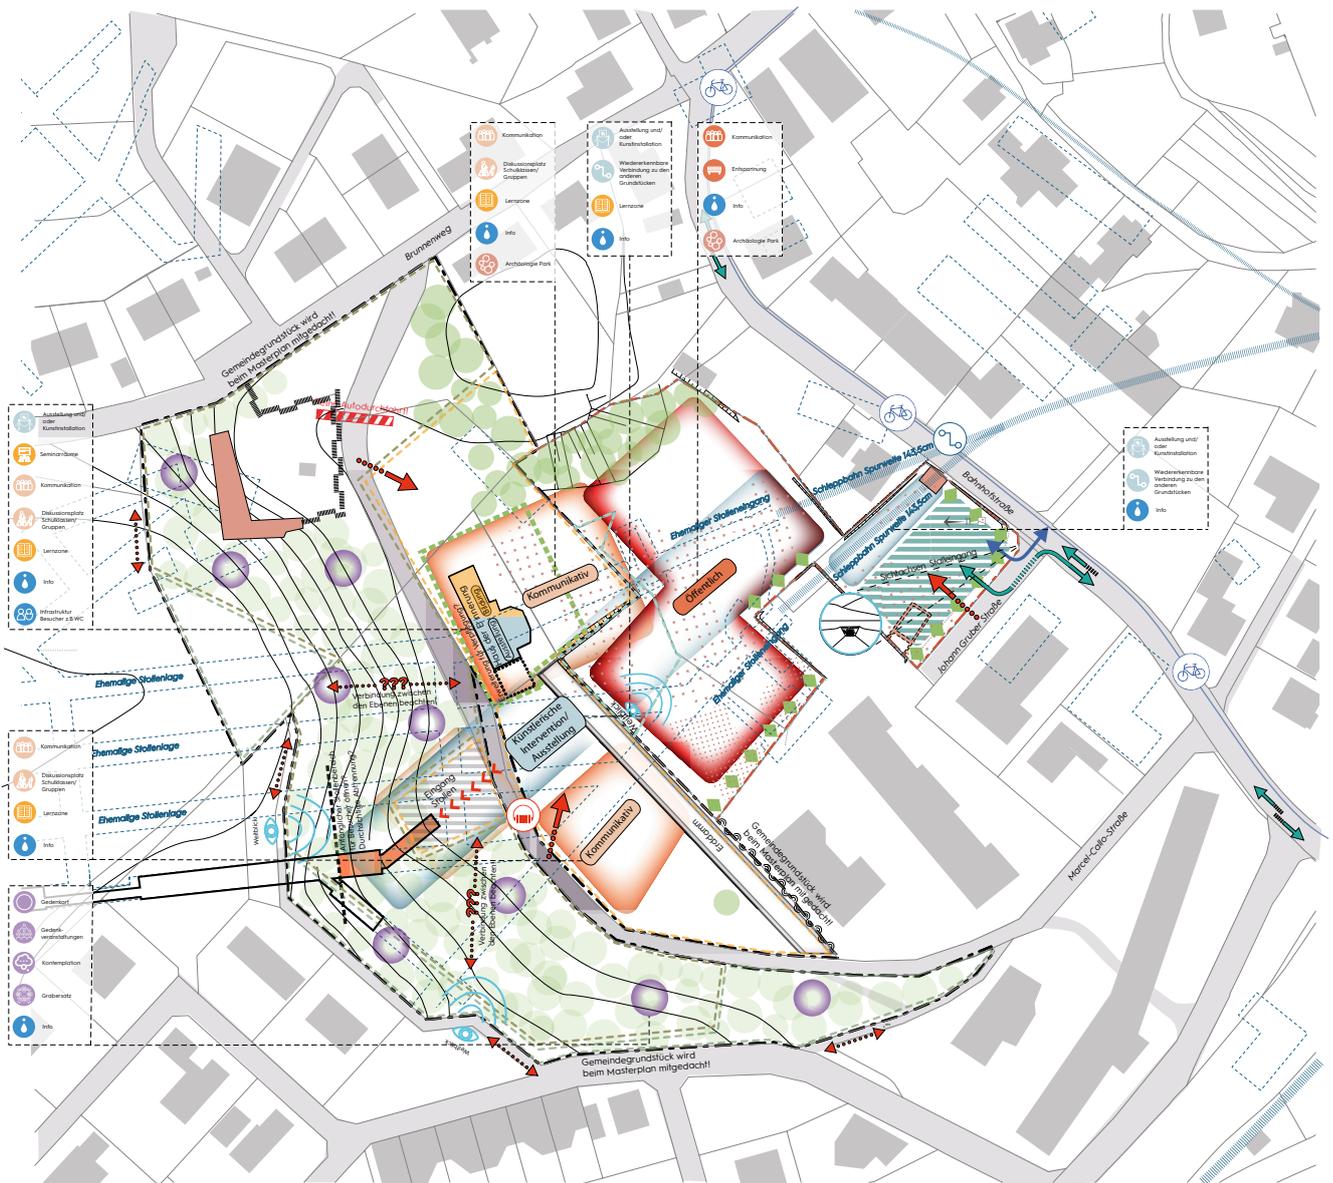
Masterplan Grundriss „Bergkristall“
